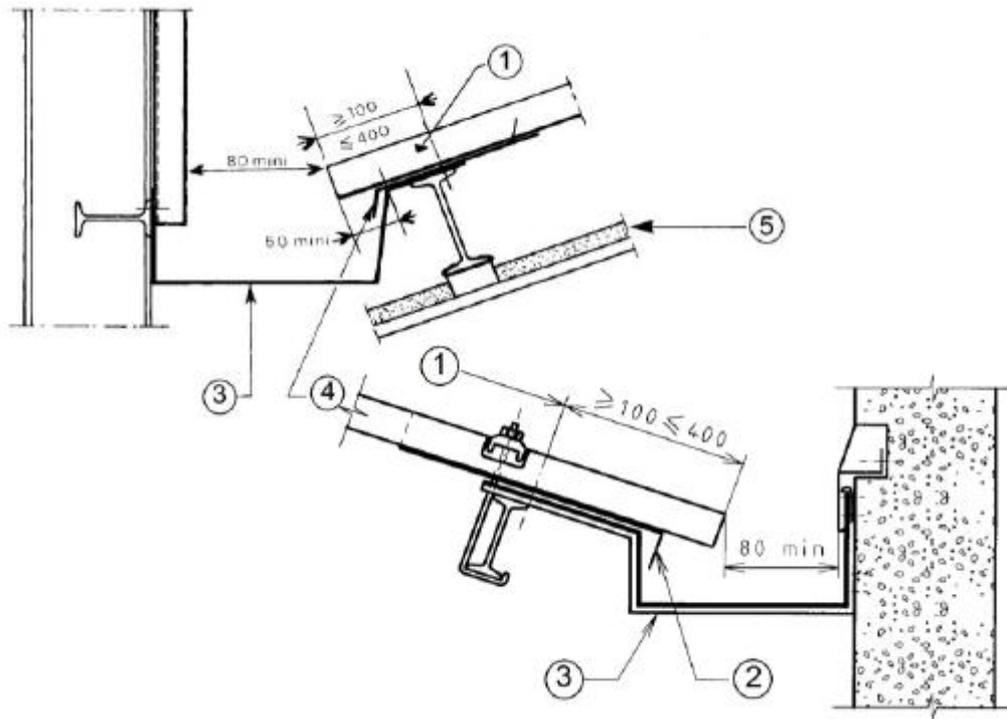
Pormenor construtivo da ligação painel-caleira interior (Pinto, 2013)
